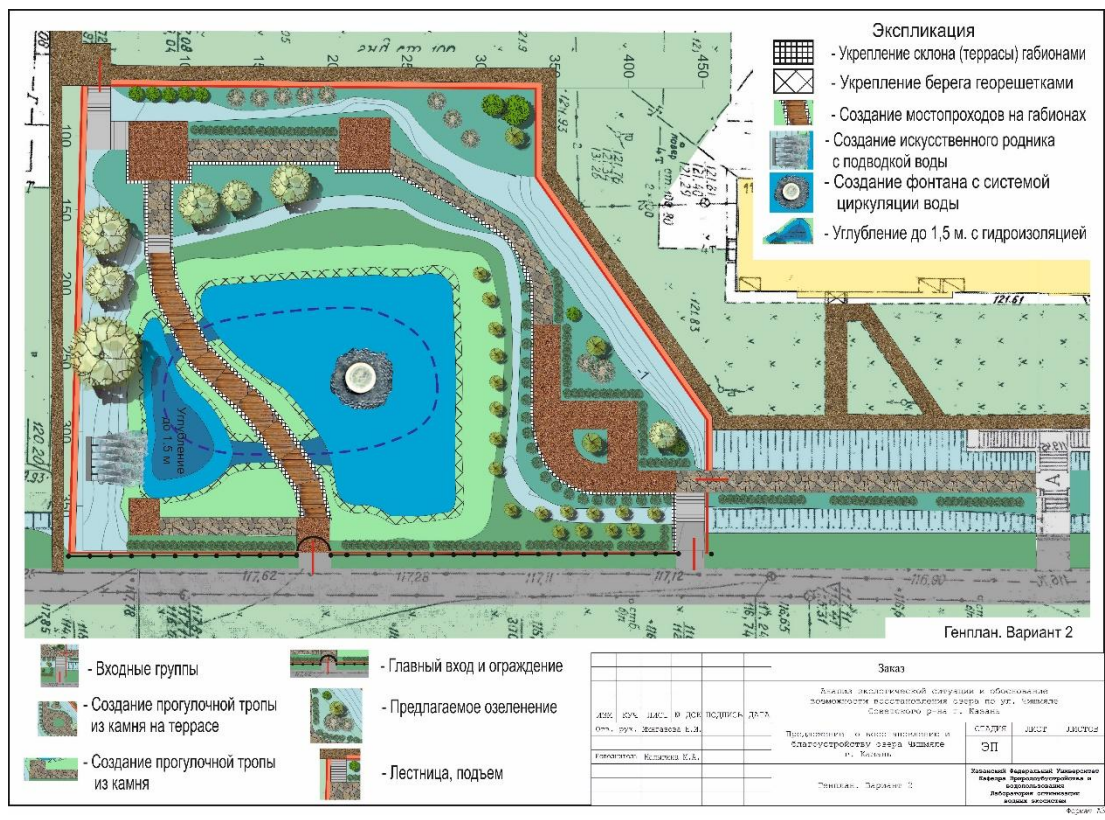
Вариант 2 эскизного генплана – генплан «Озеро Чишмяле», разработанный кафедрой Природообустройства и водопользования КФУ
